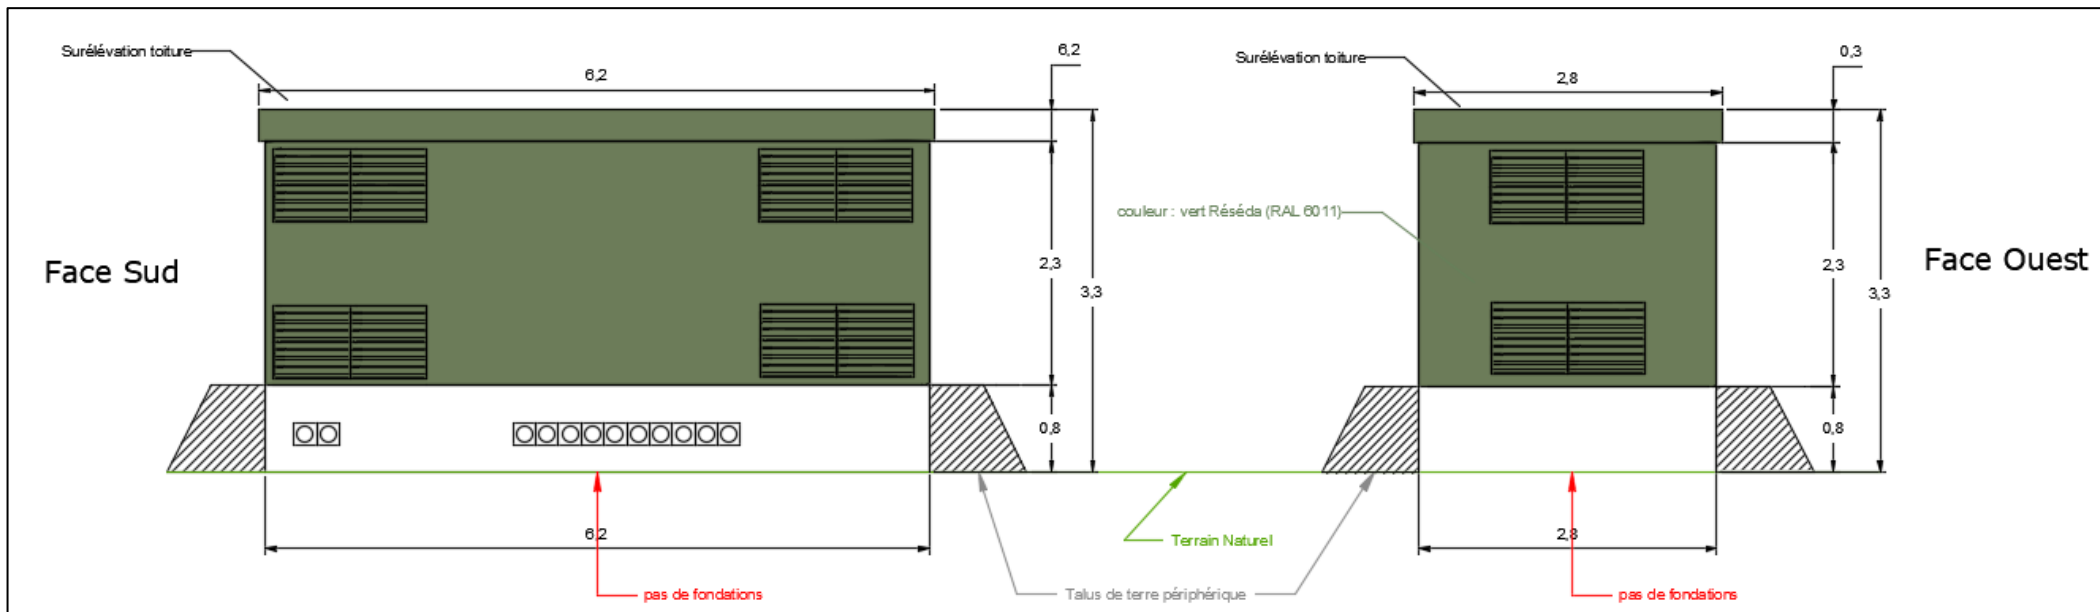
Plan de coupe des postes de livraison et de transformation (EDF Renouvelables)
